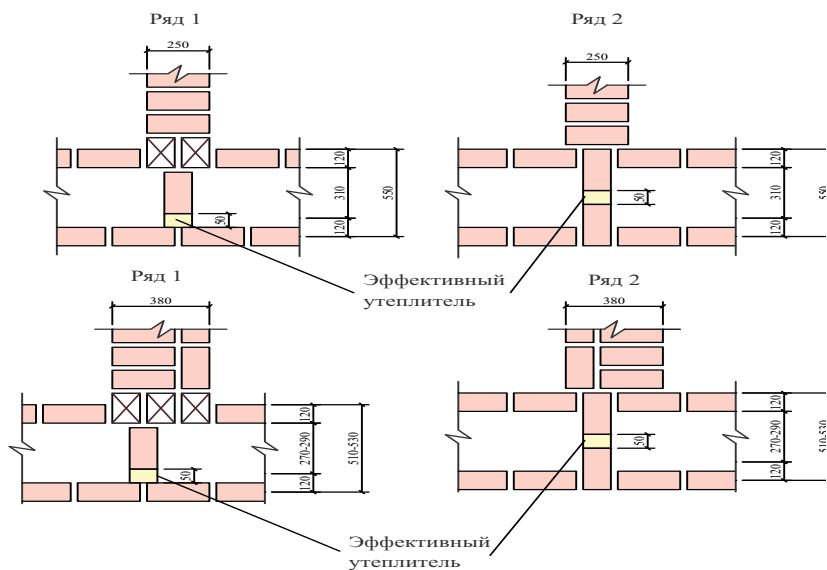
Узлы сопряжения наружной стены типа КД-1 толщиной 55 см из кирпичной кладки с вертикальными кирпичными диафрагмами с самонесущим внутренним слоем (тип КД-1)
